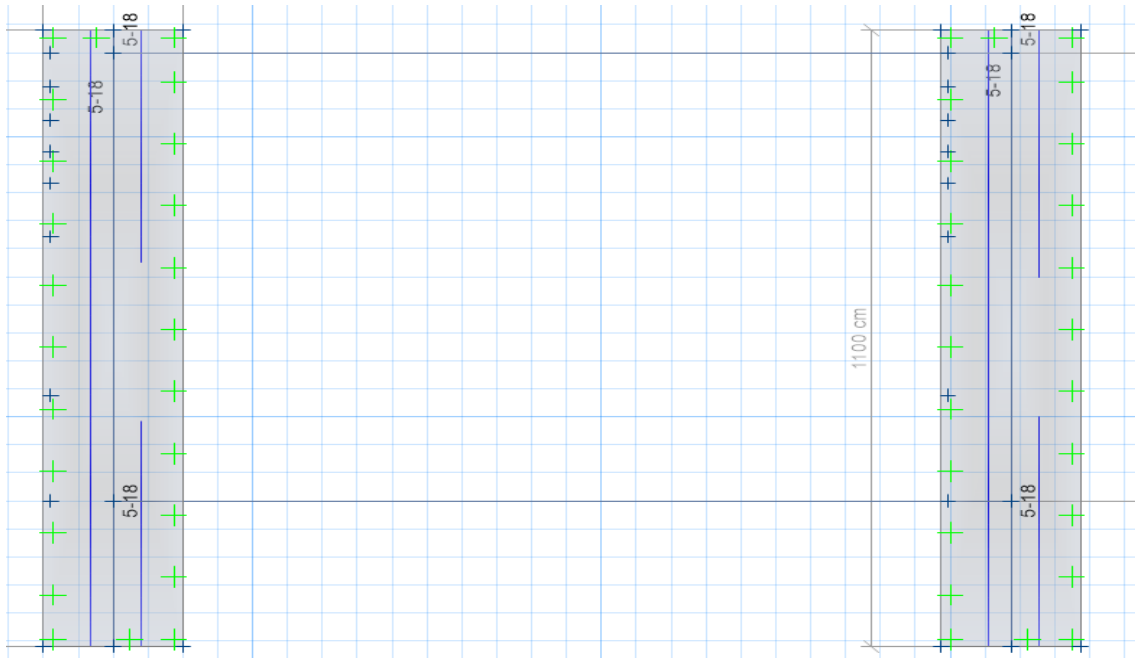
Acero de Refuerzo en zapatas corridas de la cimentación de la carga en caliente
